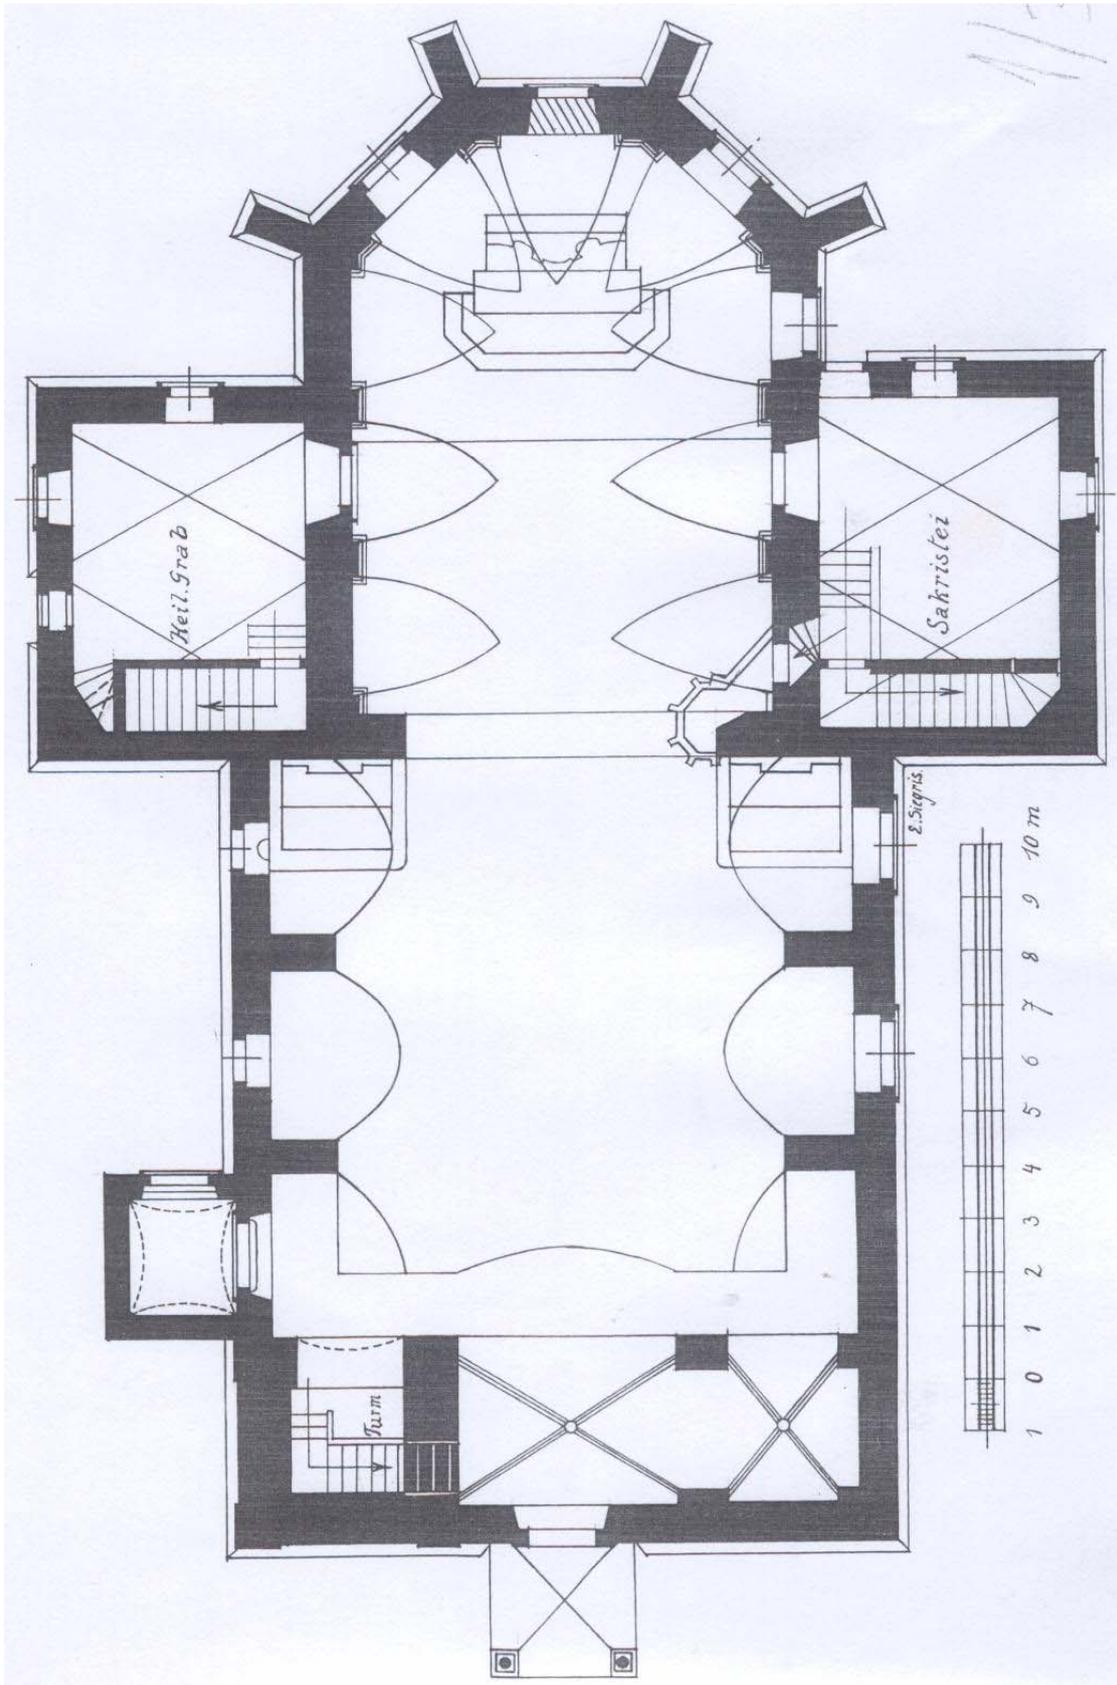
, Grundriss 5, Wulkaprodersdorf, Pfarrkirche³²⁶
